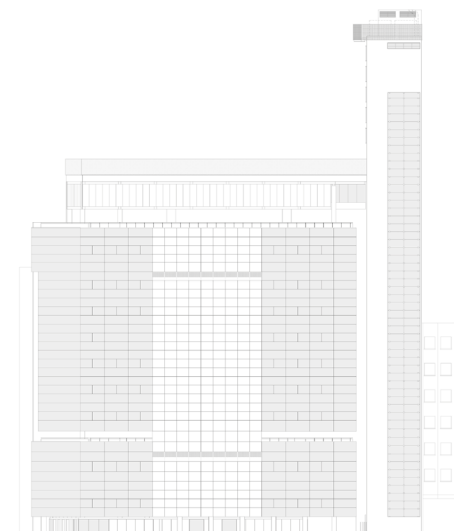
Fachada Calle Dom José de Barros. (Fuente: MMBB Arquitectos).
